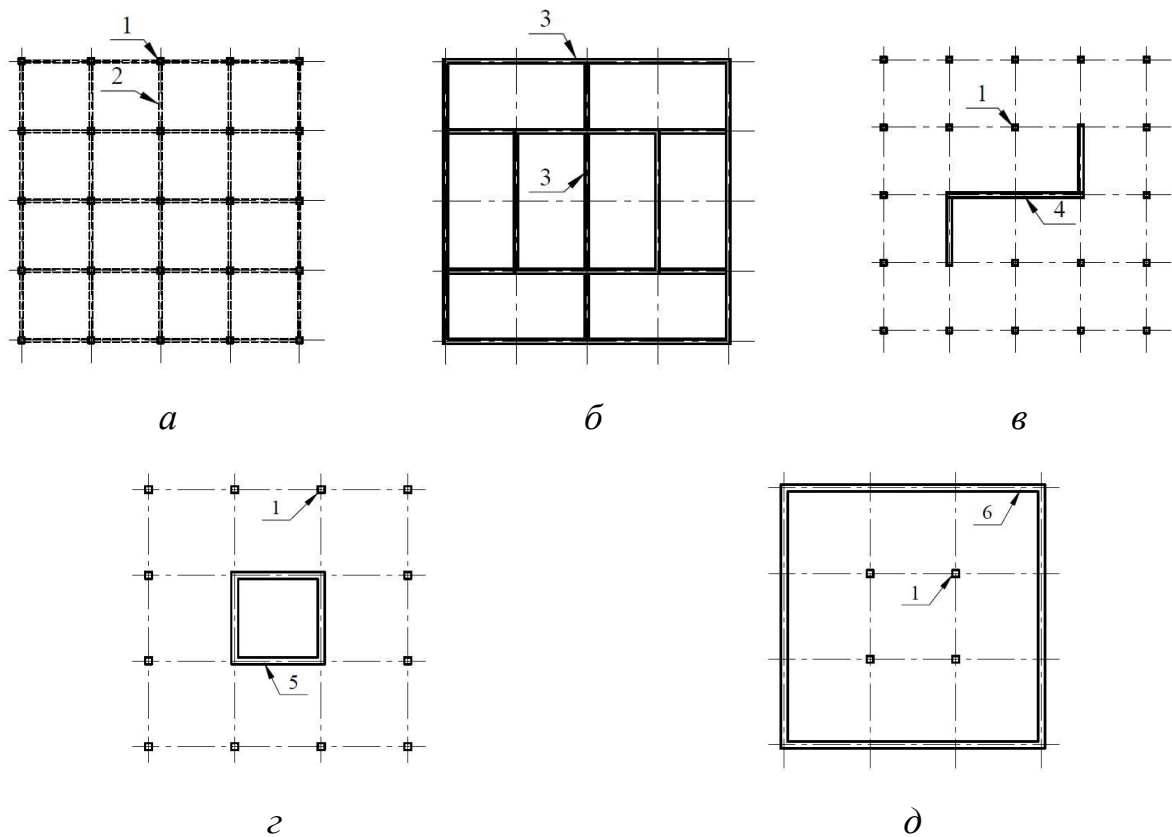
Конструктивні схеми гібридних деревозалізобетонних багатоповерхових будівель:
